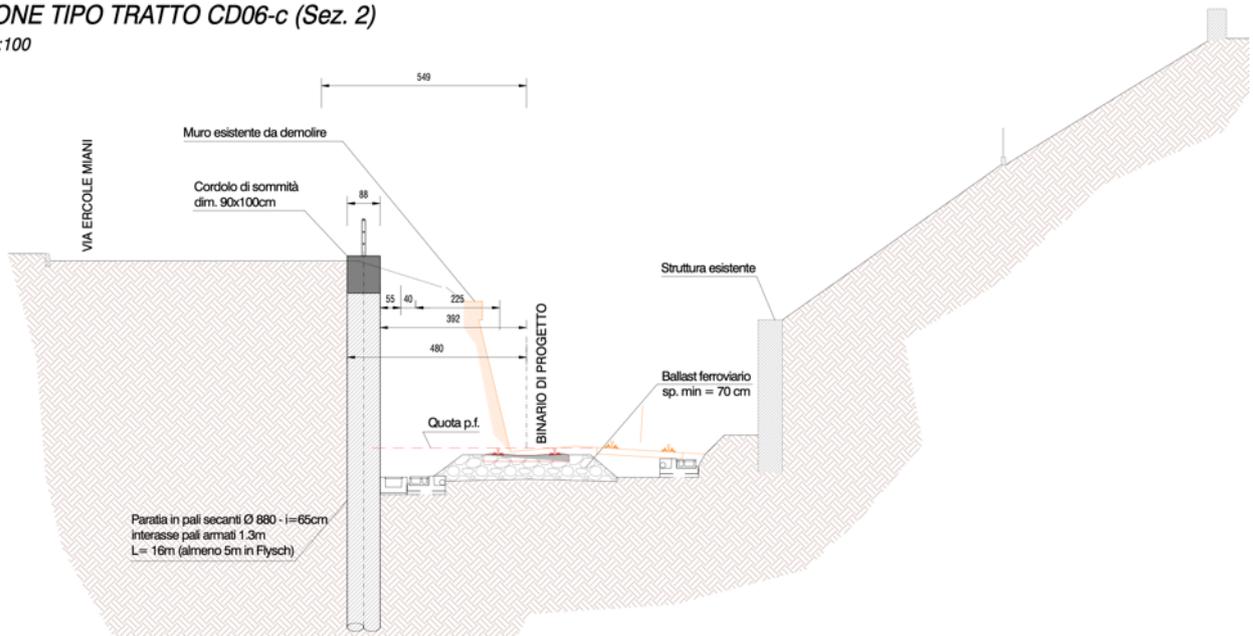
sezione tipo tratto CD06-c: tratto in trincea lungo l'asta di manovra
